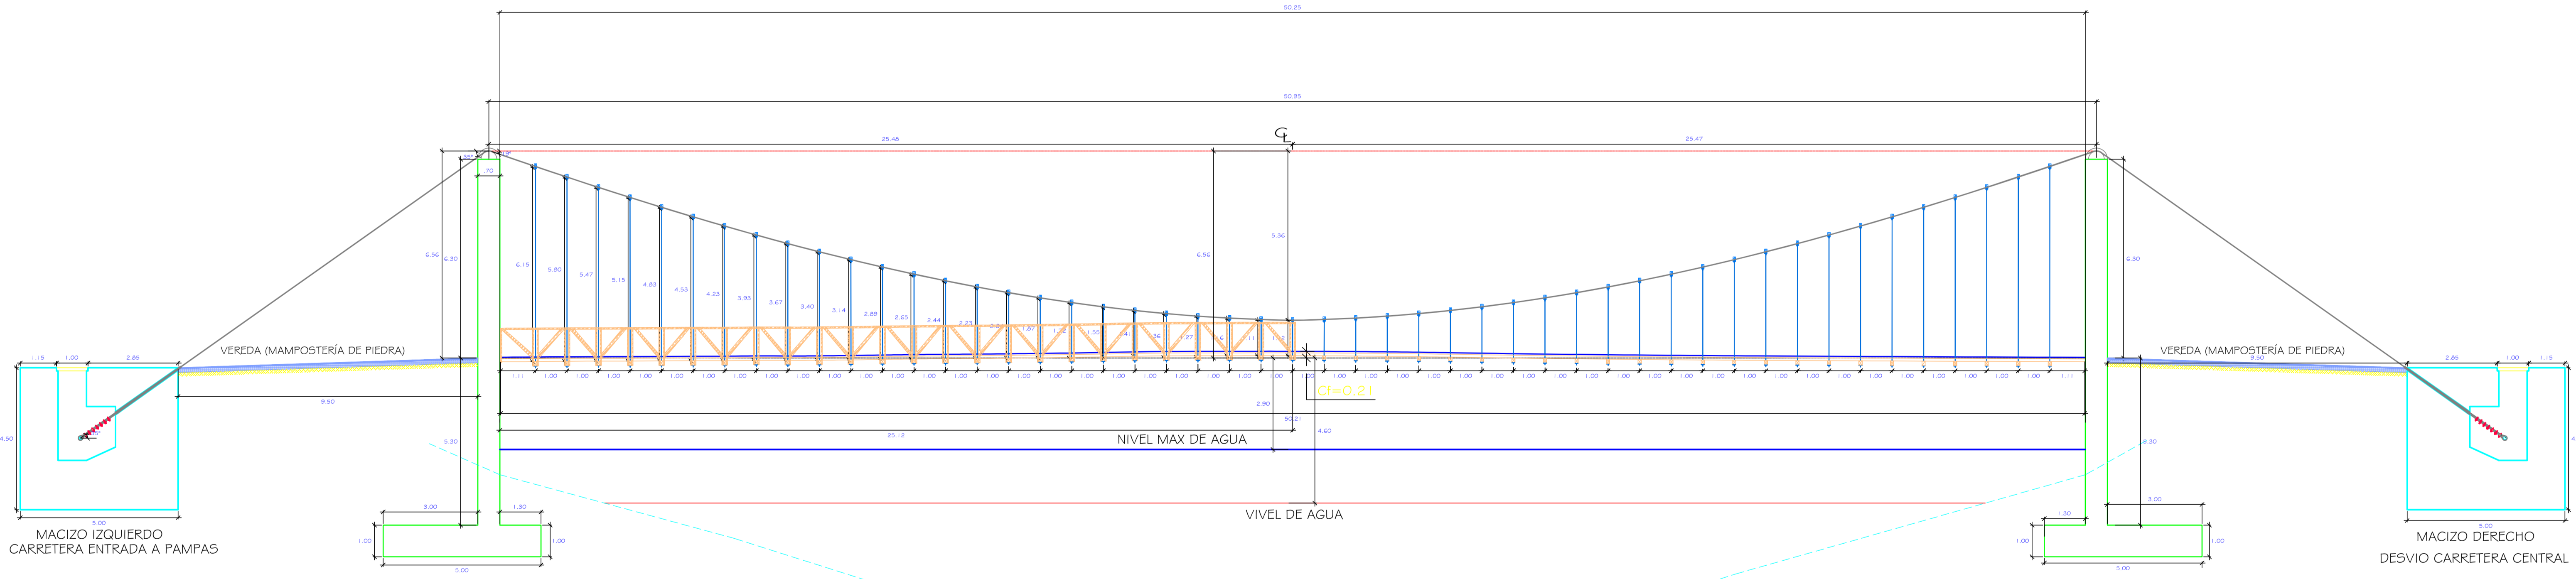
Puente colgante de madera de las Pampas inspeccionada en el 2018.
